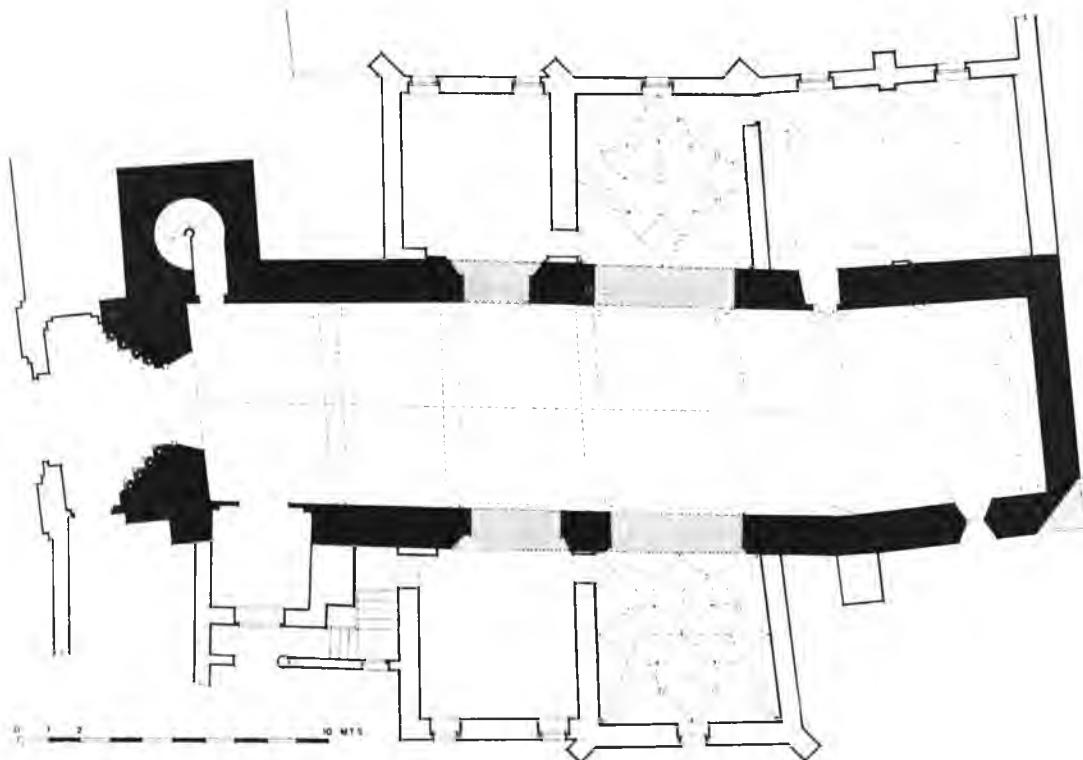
Iglesia parroquial de Santa María Magdalena, en Tudela; planta, quizá sobre la precedente mozárabe.
